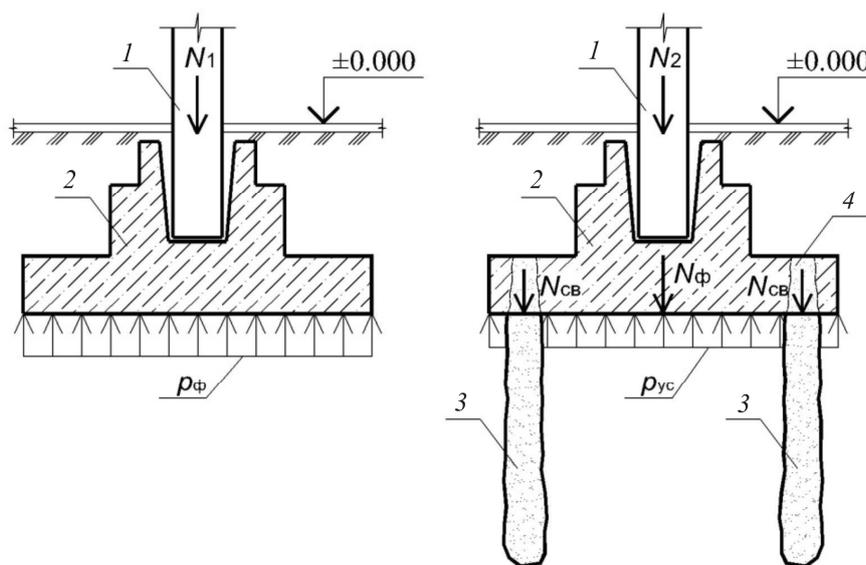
Схема распределения внешней нагрузки от реконструируемого здания между элементами фундамента: *a* – до его усиления; *b* – после его усиления инъекционными сваями; *1* – колонна; *2* – отдельный фундамент; *3* – инъекционная свая; N_1 – нагрузка на фундамент до реконструкции здания; N_2 – нагрузка на фундамент после реконструкции здания; N_ϕ – нагрузка, передаваемая на плитную часть отдельного фундамента в условиях реконструкции здания; $N_{св}$ – нагрузка, передаваемая на инъекционные сваи; p_ϕ – давление по подошве отдельного фундамента до его усиления; p_{yc} – давление по подошве отдельного фундамента после его усиления
